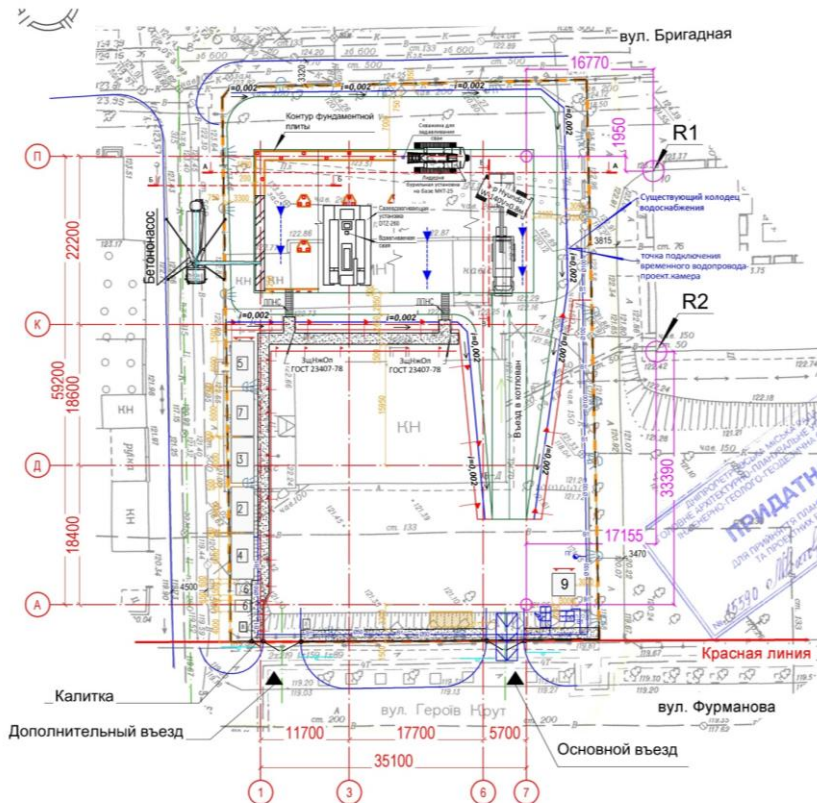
Фрагмент будівельного генерального плану на період земляних робіт та зведення нульового циклу
